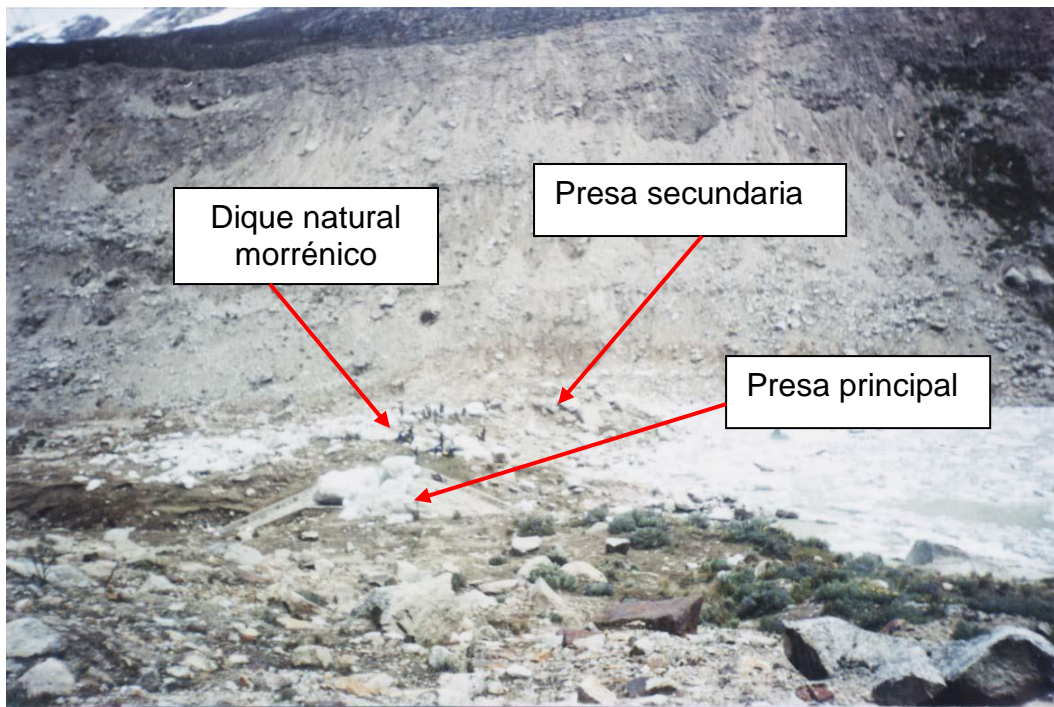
En primer plano se ven las aletas de entrada, el conducto cubierto de sección circular y el talud interior de la presa artificial de la laguna Palcacocha.
